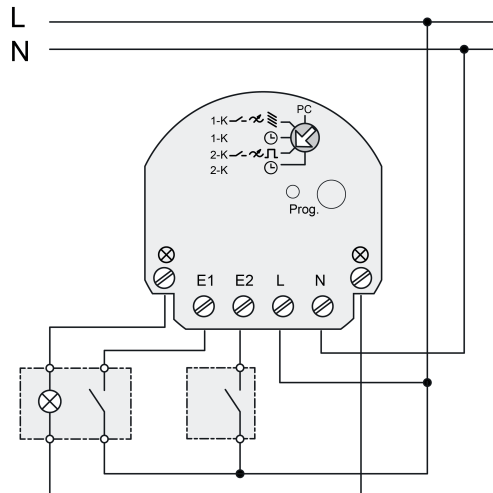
Esempio di collegamento con tasto e spia di segnalazione
